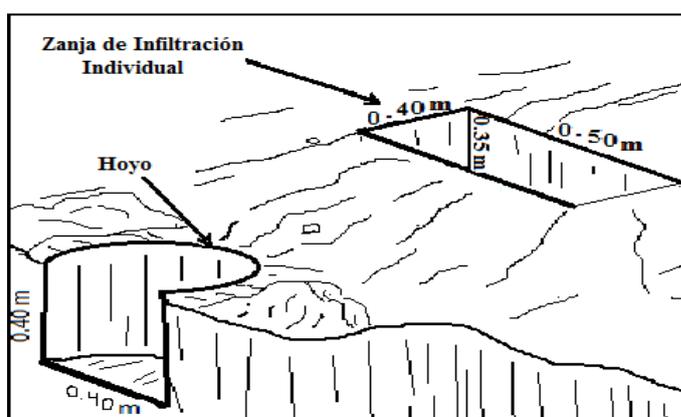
Perfil de zanjas de infiltración individual y hoyos
